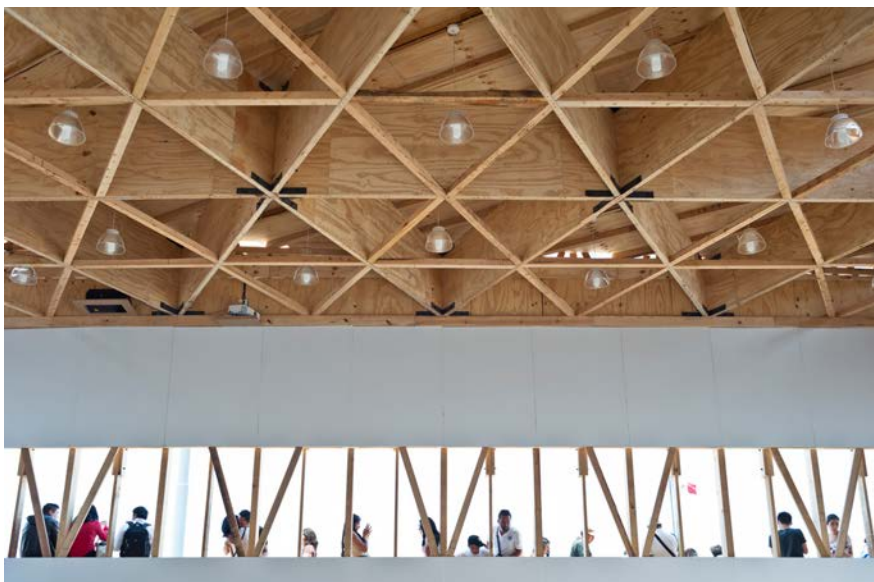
Vista de la estructura del cielo (fuente: el autor, 2014).
